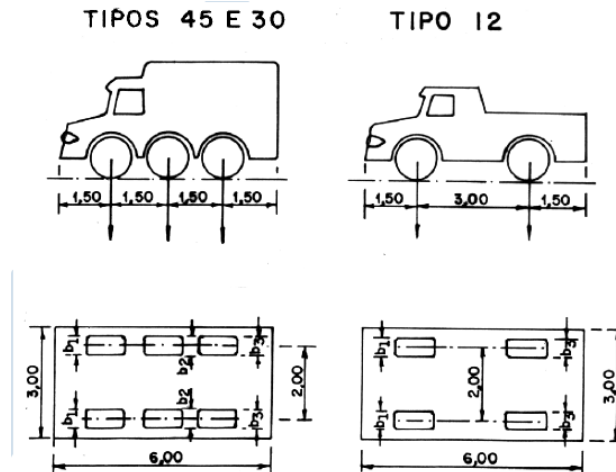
Dimensões dos veículos tipo segundo a norma Brasileira, em perfil longitudinal (em cima) e em planta (em baixo) (NBR-7188, 1982).
